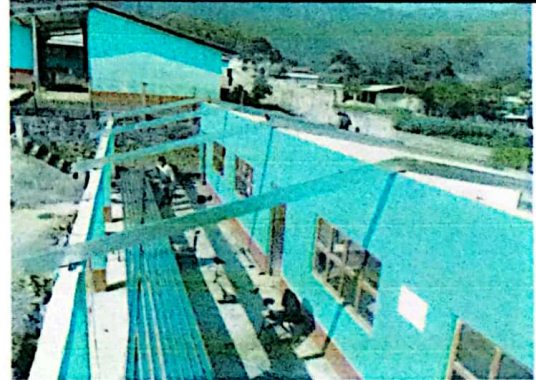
Situación colocando la estructura nueva edificio dos parte baja.
